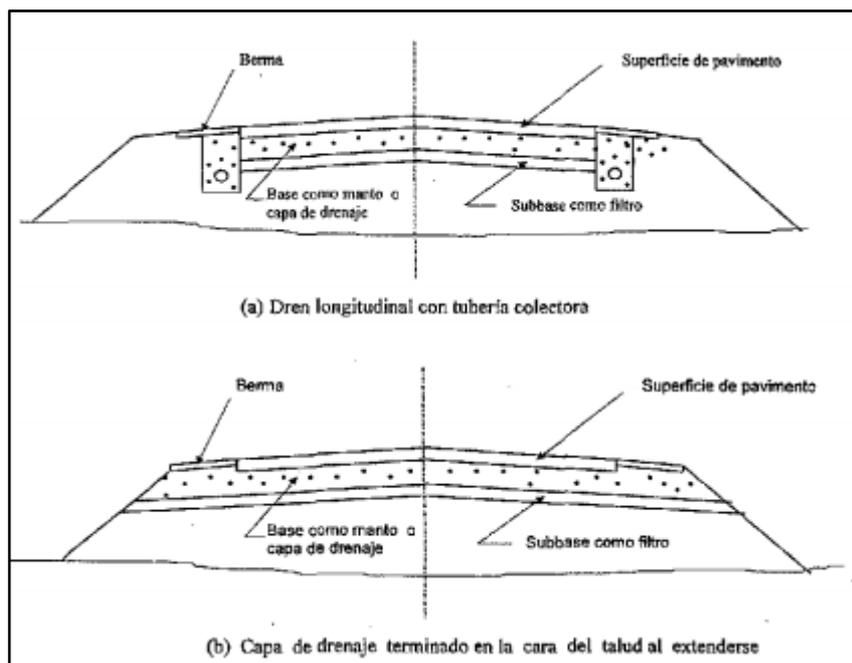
Manto de drenaje con un dren longitudinal alternativo
